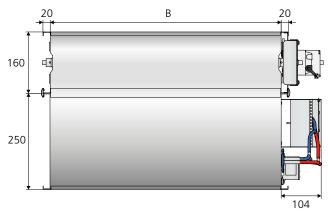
Abmessungen, WISE Damper rechteckig, WISE Damper rechteckig mit Federrücklauf.
